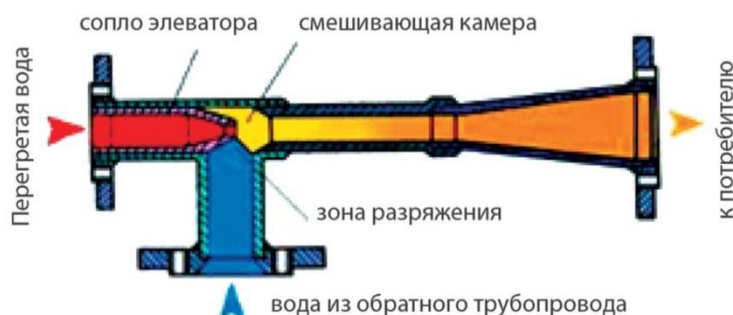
Принципова схема конструкції елеваторного вузла
